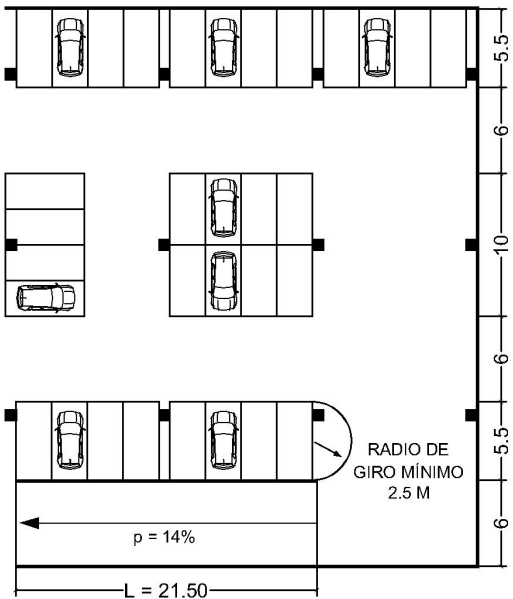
Planta y sección de cálculo de pendiente de rampa.
